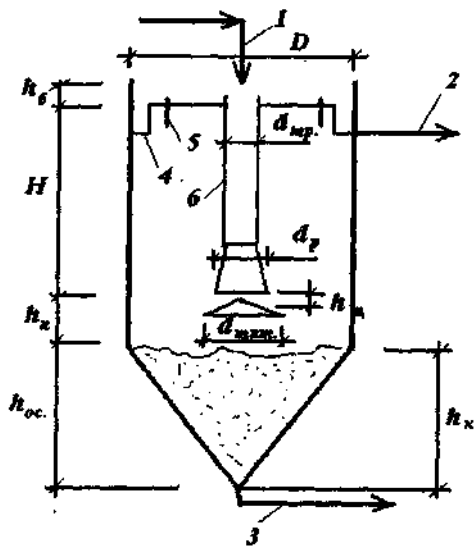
Розрахункова схема вертикального відстійника:
